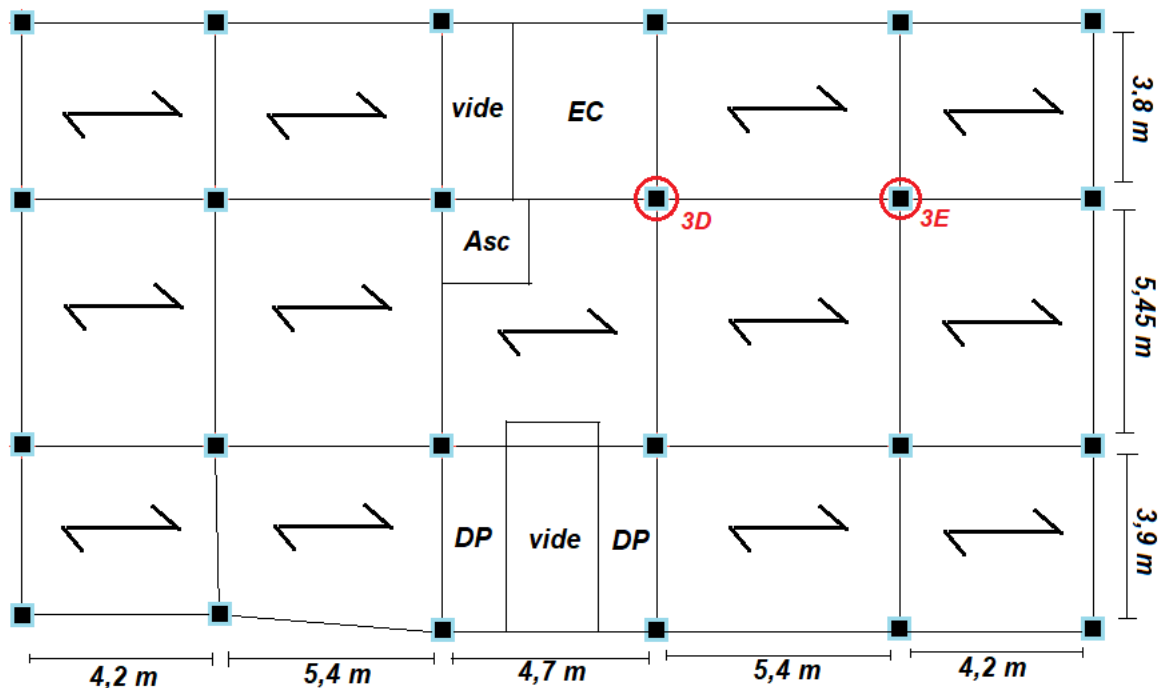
vue en plan de la disposition des poutrelles étage courant
